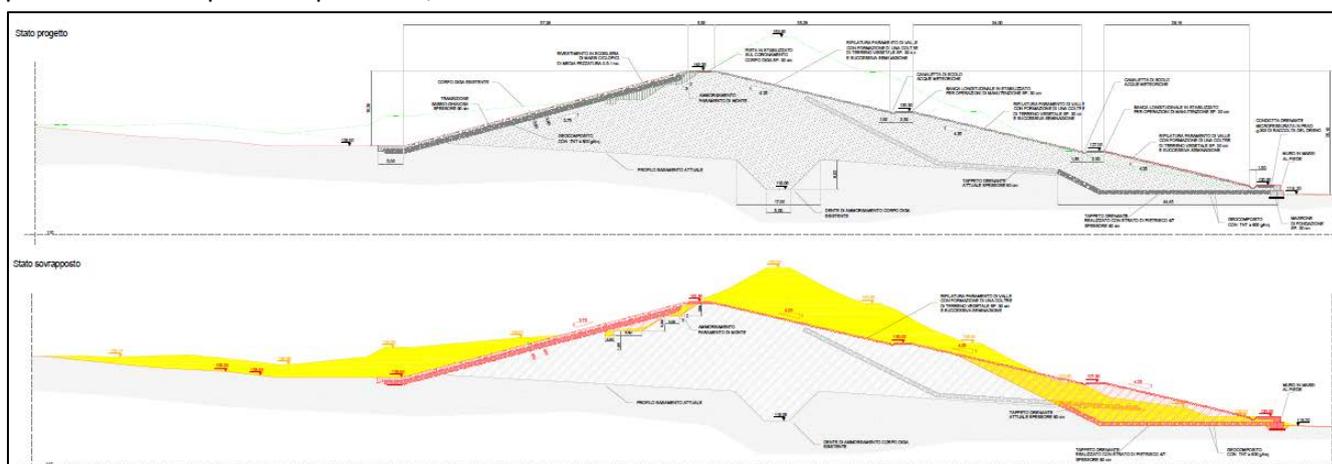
Sezione diga di progetto Tav EG.14 sezioni caratteristiche diga
